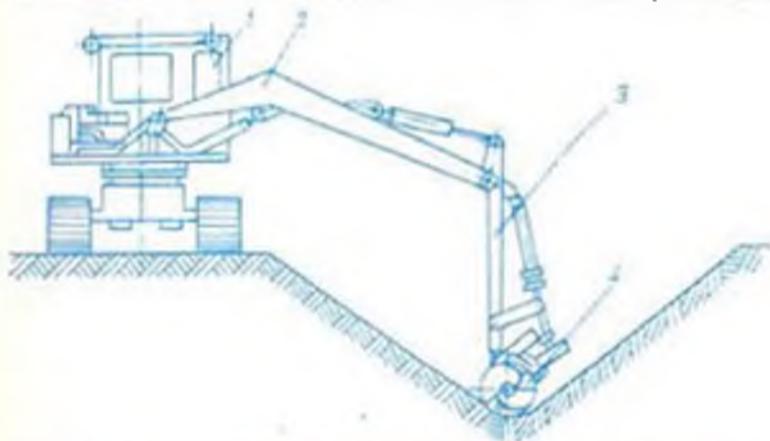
Схема каналочистителя со сменными рабочими органами: 1 — базовая машина; 2 — стрела; 3 — рукоять; 4 — шнек с метателем.
